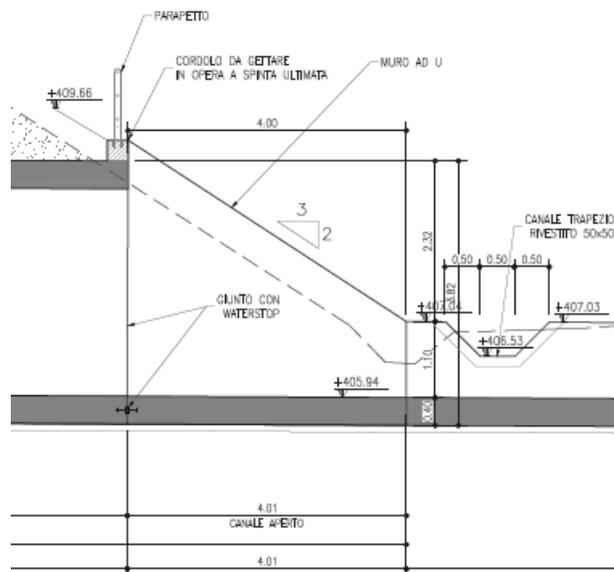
Manufatto di sbocco - Sezione longitudinale
